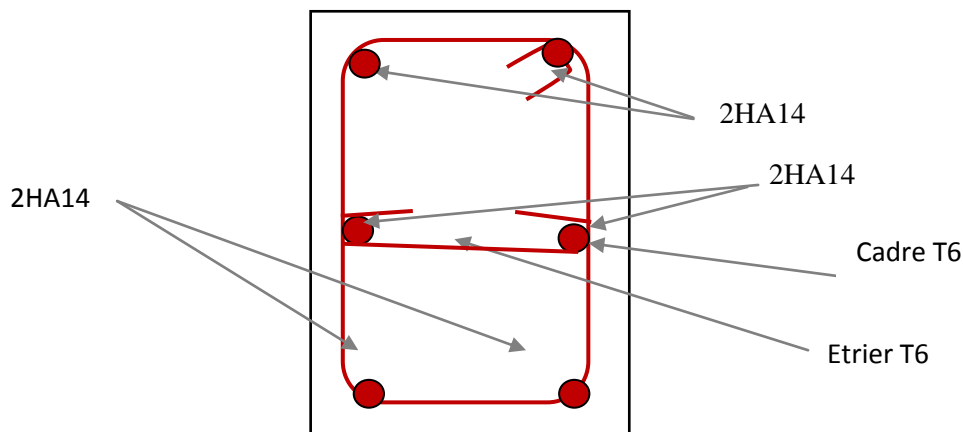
la coupe de ferrailage de la poutre brisée.
